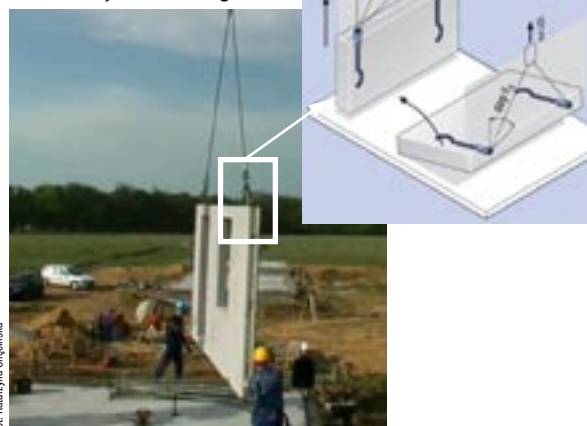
Dostawianie prefabrykowanych ścian [4]
